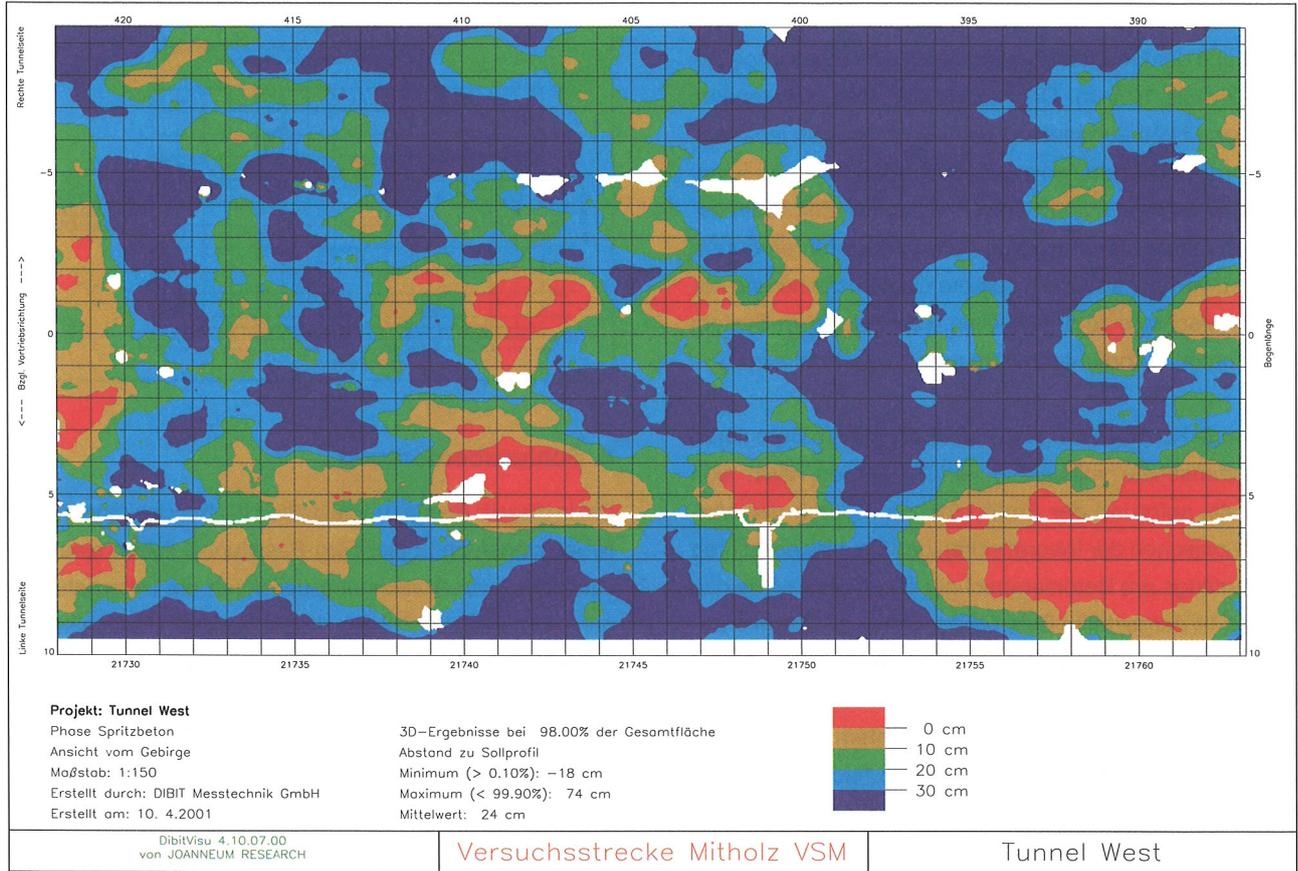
Flächenauswertung Versuchsstrecke Mitholz
